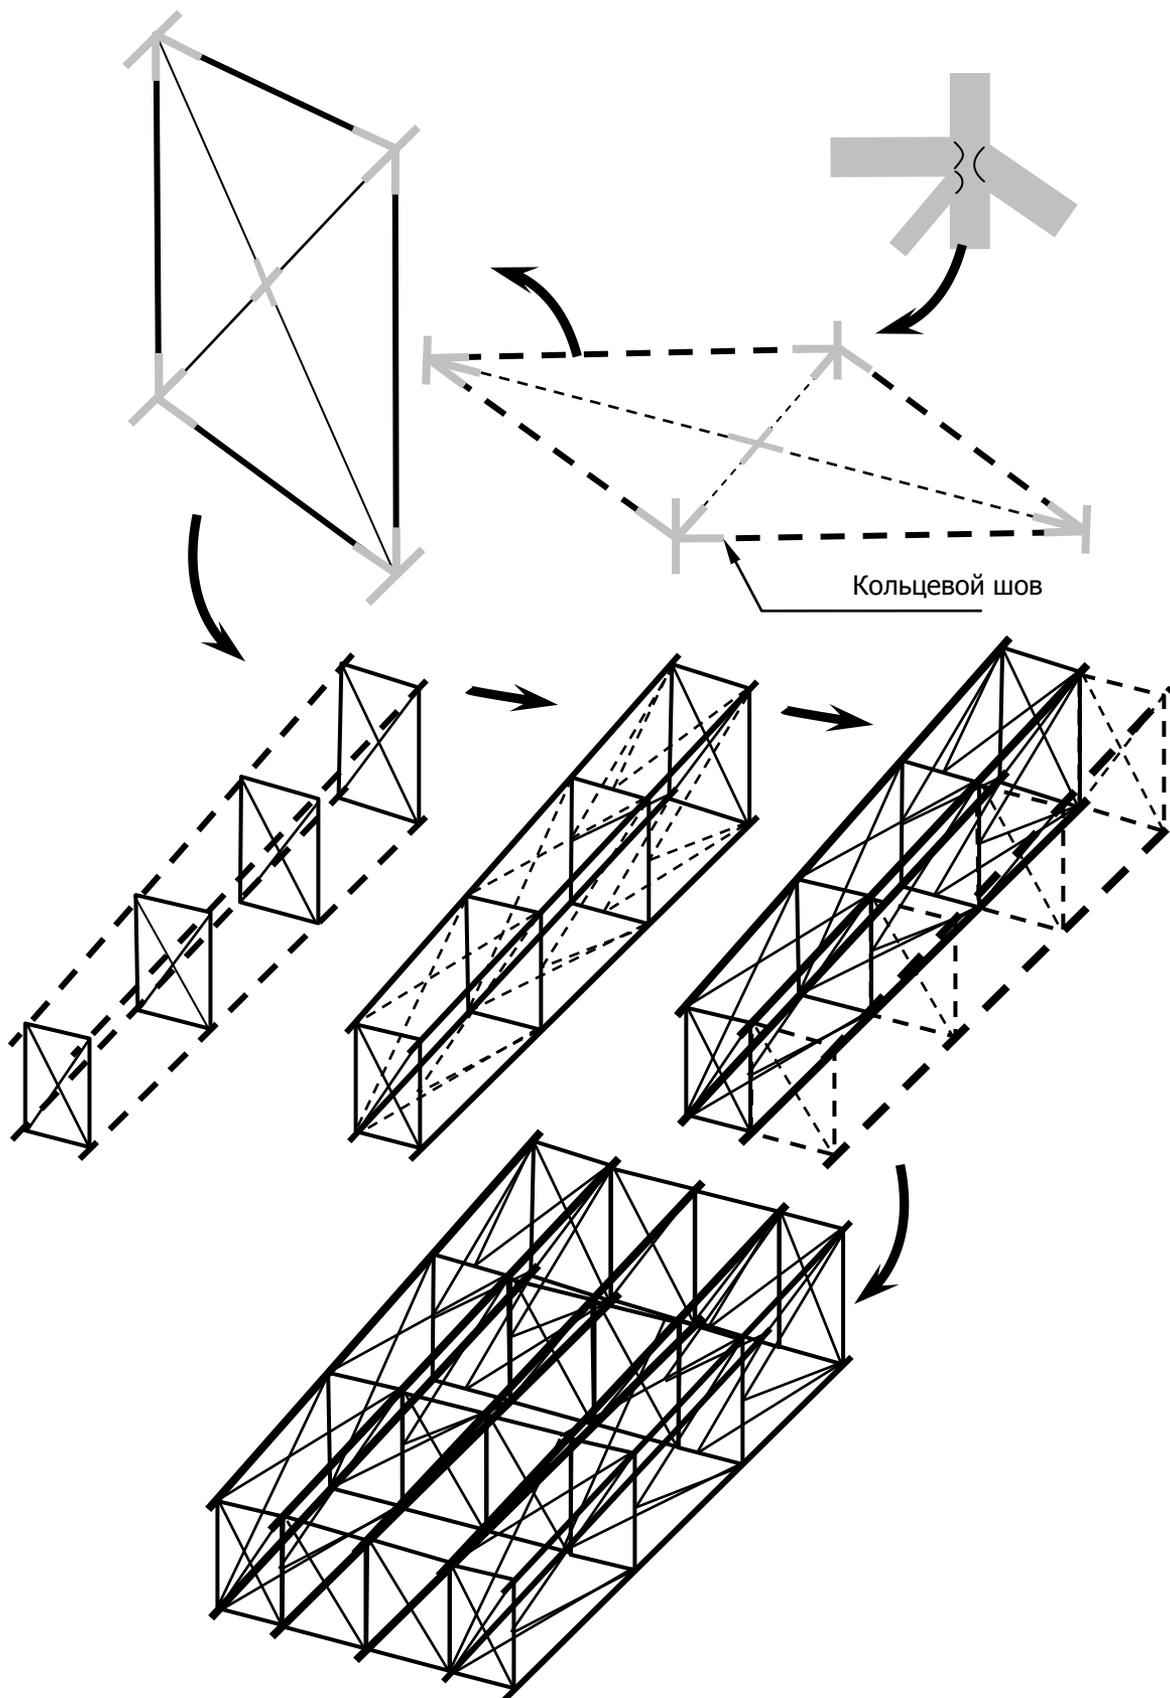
Последовательность сборки и сварки при изготовлении решетчатой конструкции опоры морской буровой платформы
